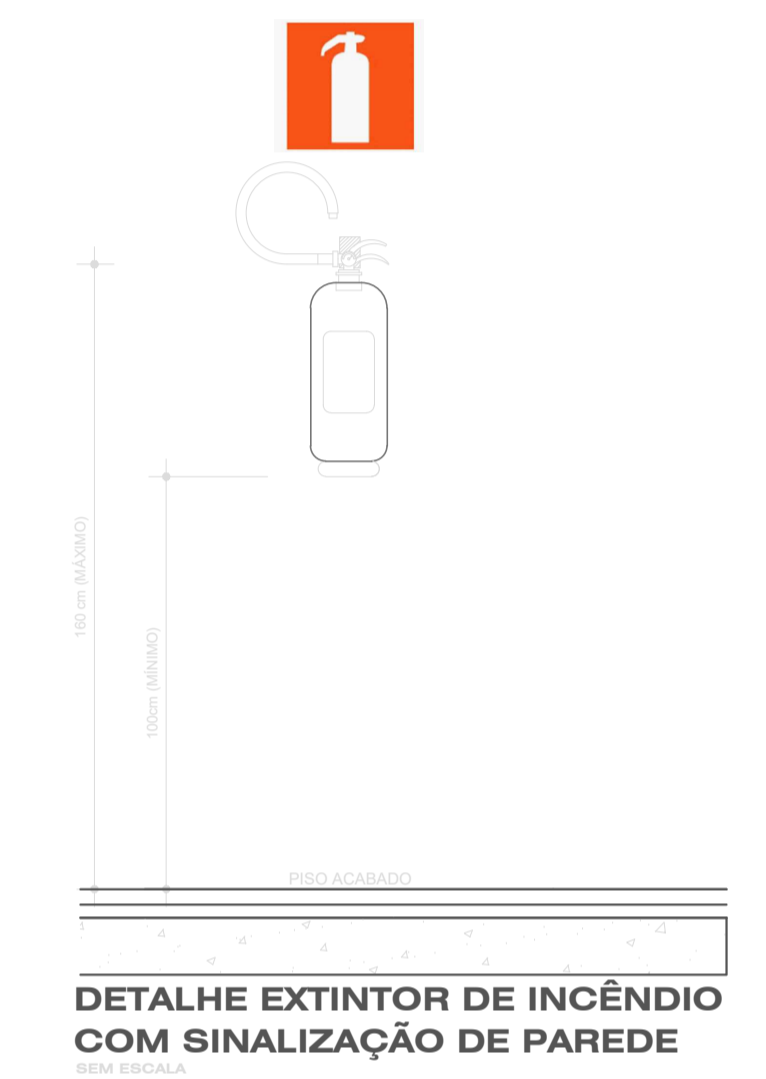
DETAILHE DE INSTALAÇÃO E SINALIZAÇÃO DE EXTINTORES SEM ESCALA
